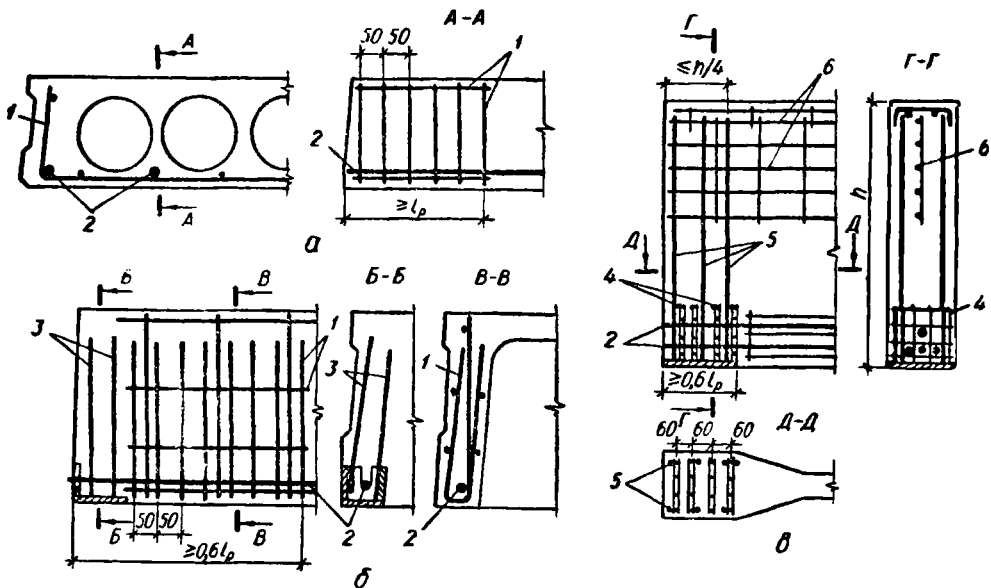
Армування кінців поперечно напружених плит та балок:
